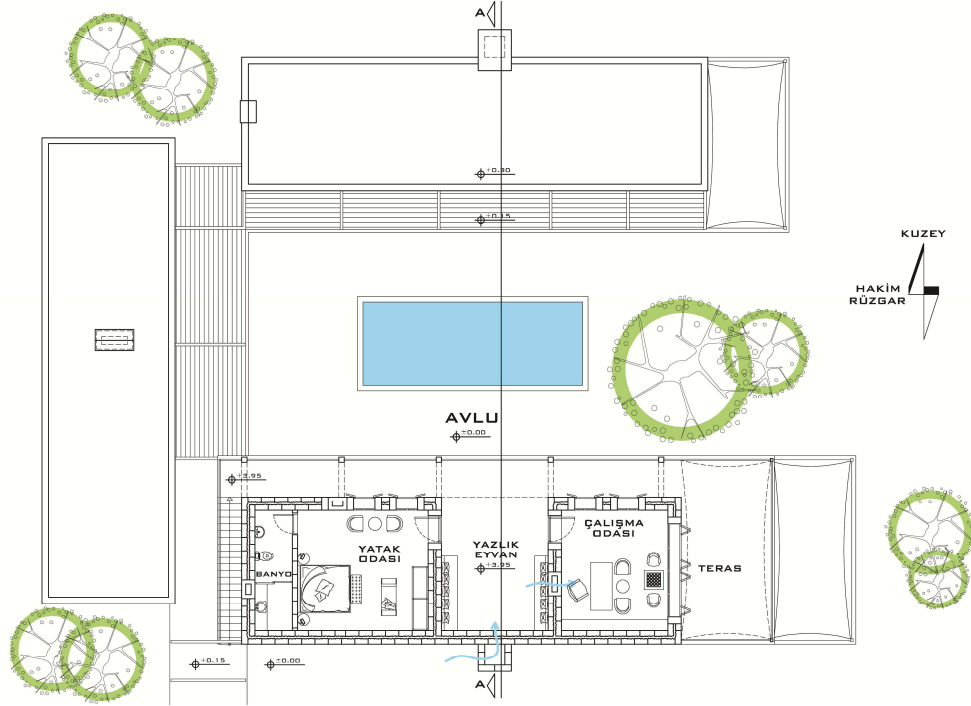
Tip 3; 5-9 kişilik aile konutunun vaziyet planı
